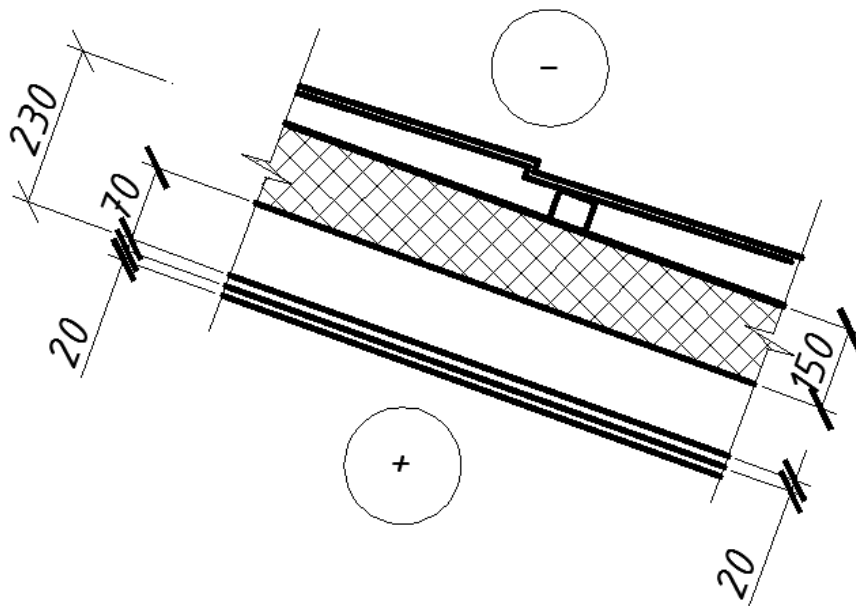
Поперечный разрез кровли мансардного этажа
